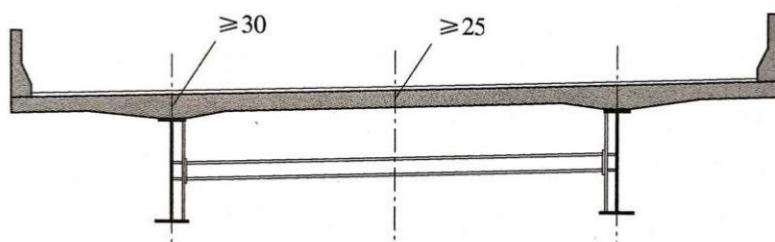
混凝土桥面板构造尺寸要求（尺寸单位：cm）
